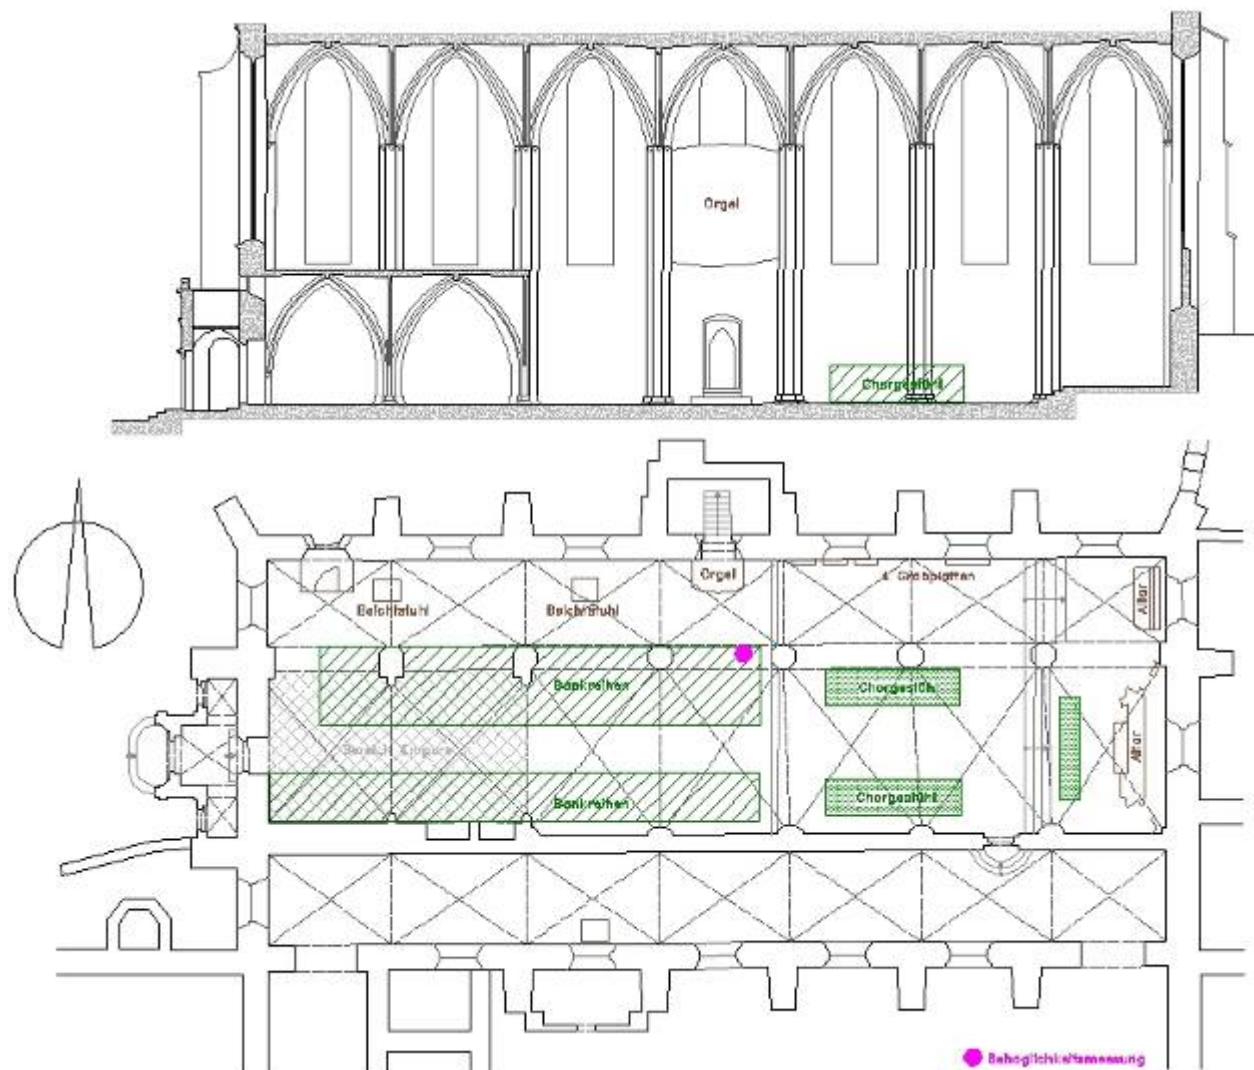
Grundriss und Schnitt der Klosterkirche St. Marienstern mit dem Messpunkt der Behaglichkeitsmessung
